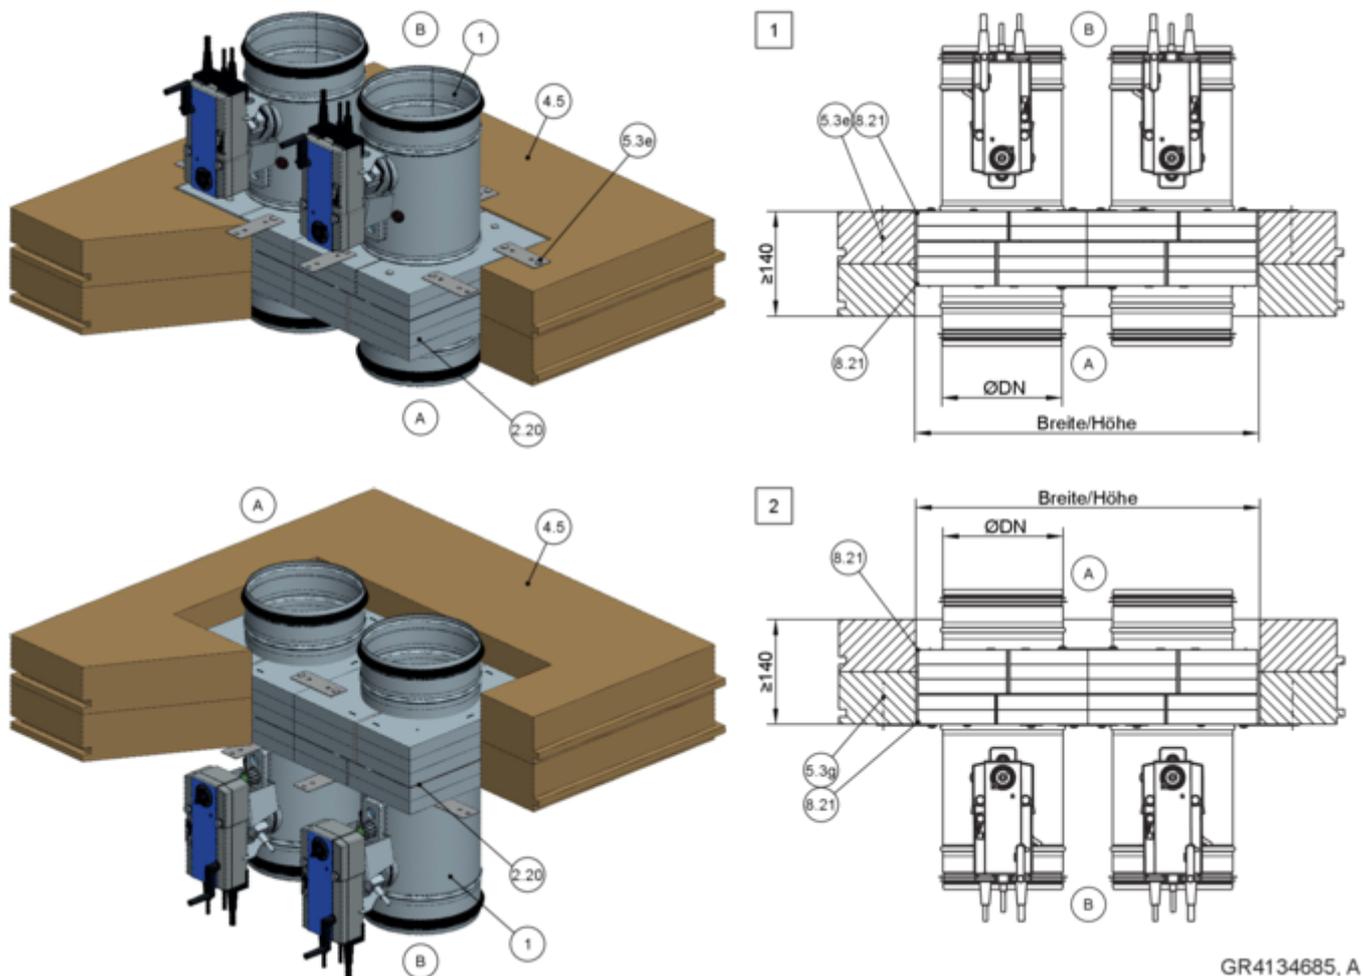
Trockeneinbau in Vollholzdecke mit Einbausatz TQ2, stehend und hängend
